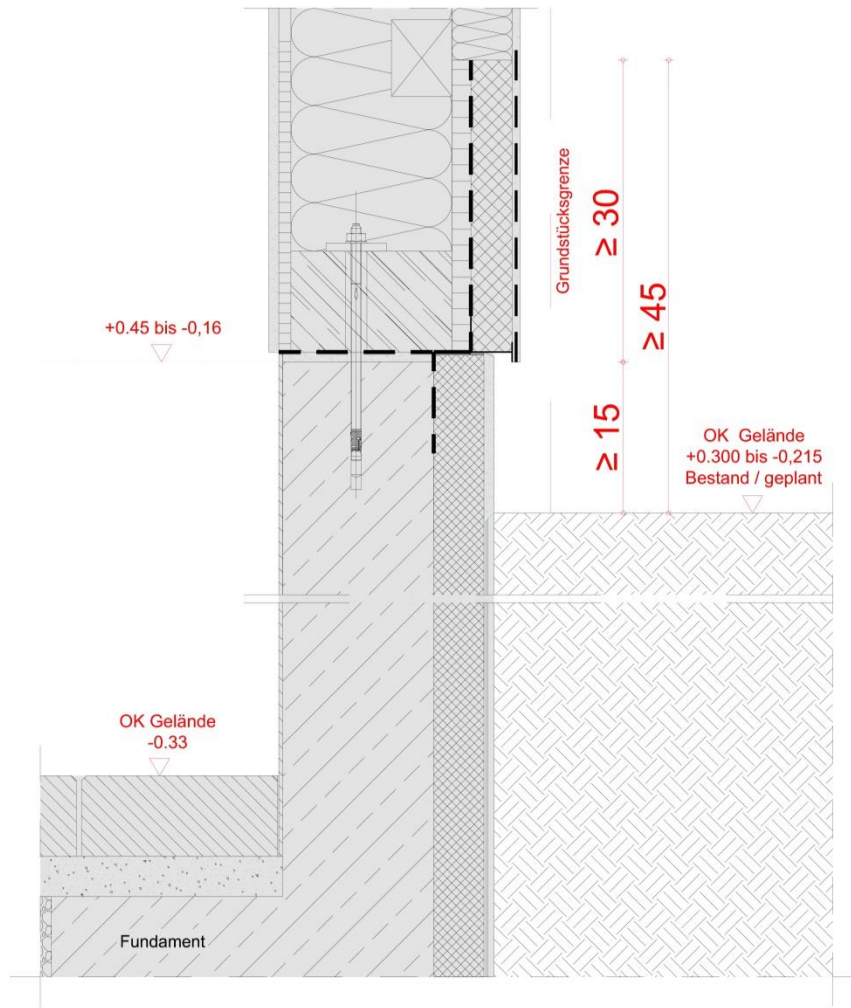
LUXHAUS Sockeldetail 15 - Garage mit Betonaufkantung, Bebauung an Grenze
